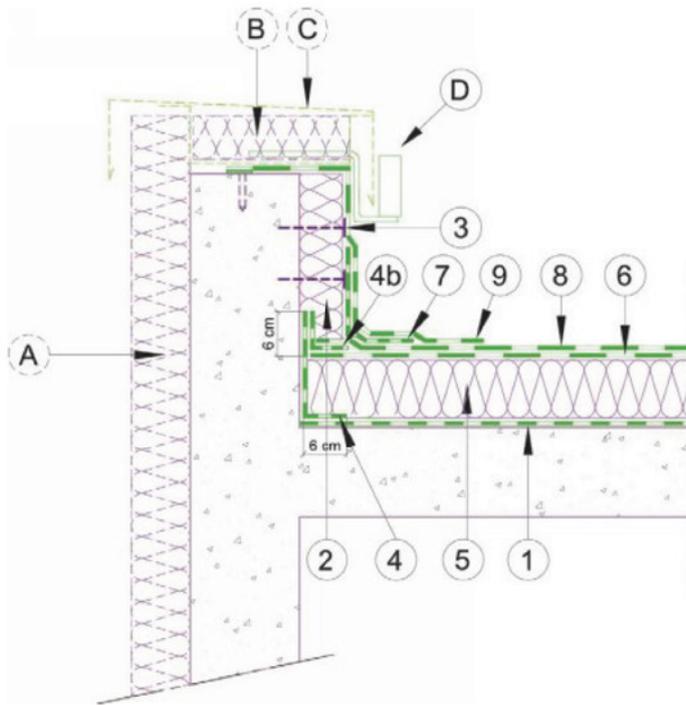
Relevé d'étanchéité sur isolant apte à recevoir un revêtement bitumineux soudé (laine minérale, et perlite) apparent, variante de la figure 1
